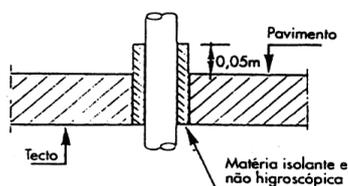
Passagem de tubos de um piso a outro [45]
